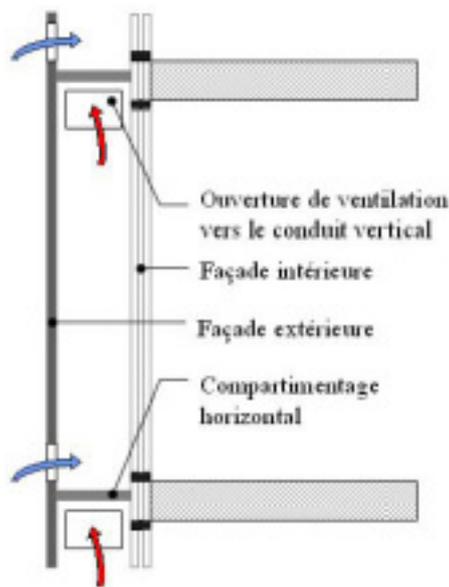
BÂTIMENT AVEC FAÇADE VENTILÉE
